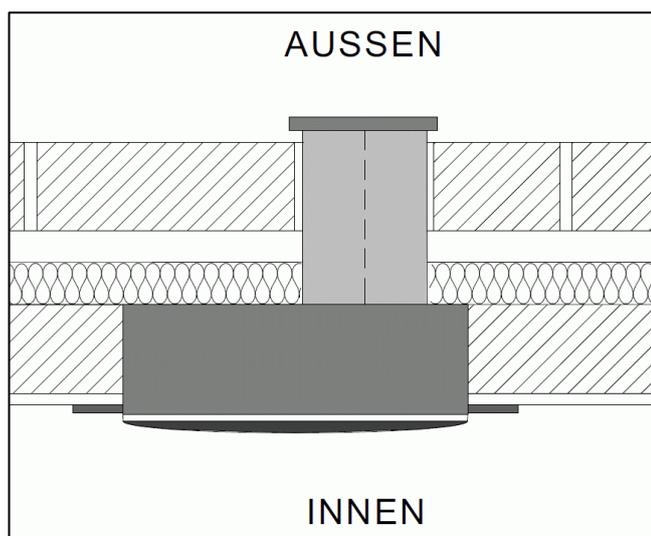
Detail A, Lüftungsanlage mit Unterputzmontage
